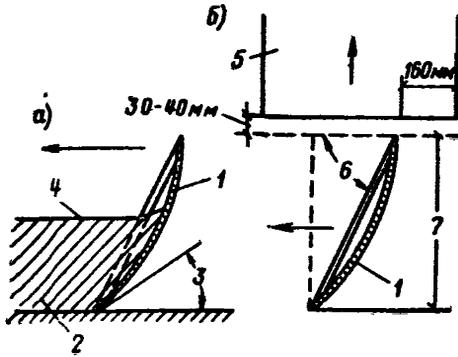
Схема установки дискового плуга грейдер-элеватора
